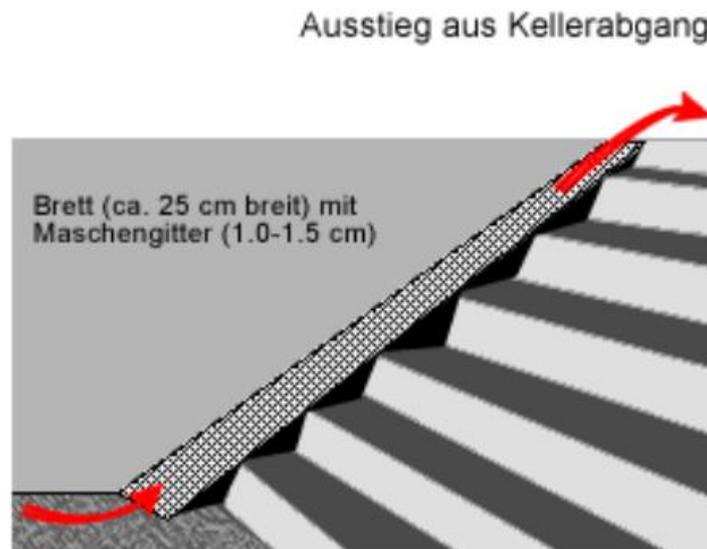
Une planche en bois équipée d'un grillage à mailles fines le long du mur de l'escalier est une mesure efficace pour aider la faune à remonter de la descente de cave (bauen-tiere.ch).
